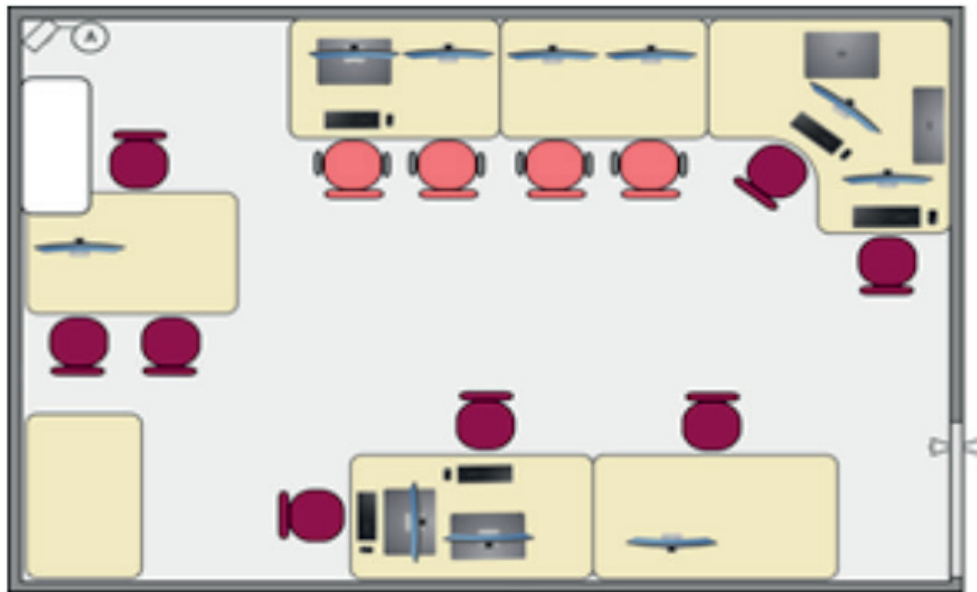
Planta baixa do cenário de instalação da câmera (A) para coleta de imagens.
